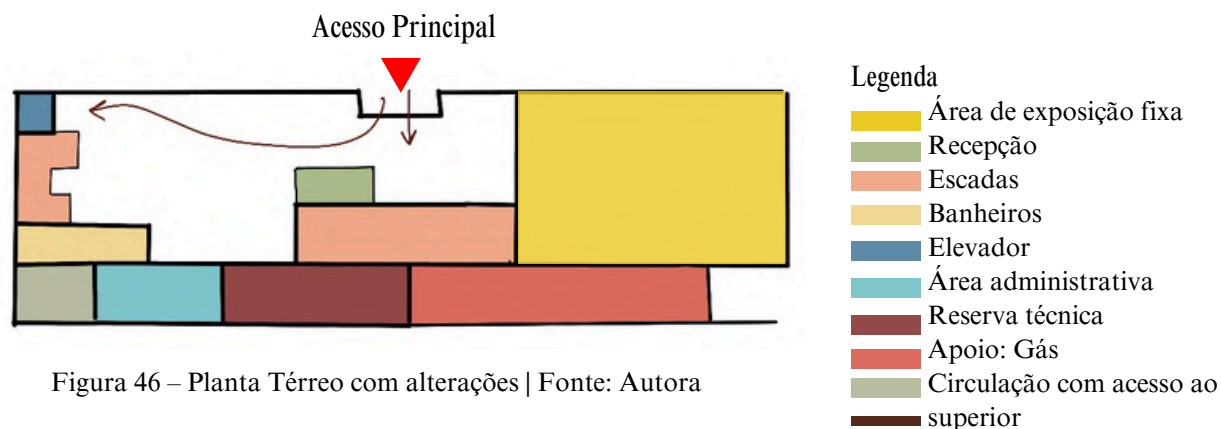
Planta Térreo com alterações | Fonte: Autora
